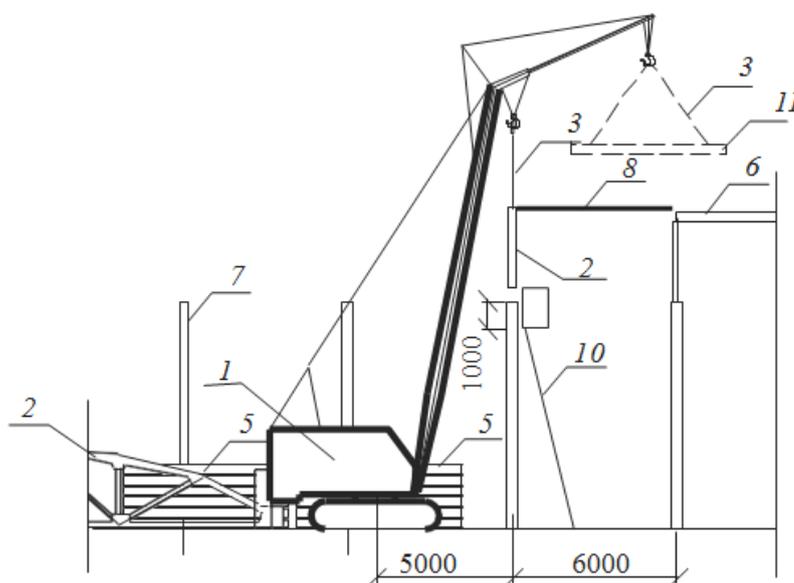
Схема монтажа элементов покрытия комплексным методом
